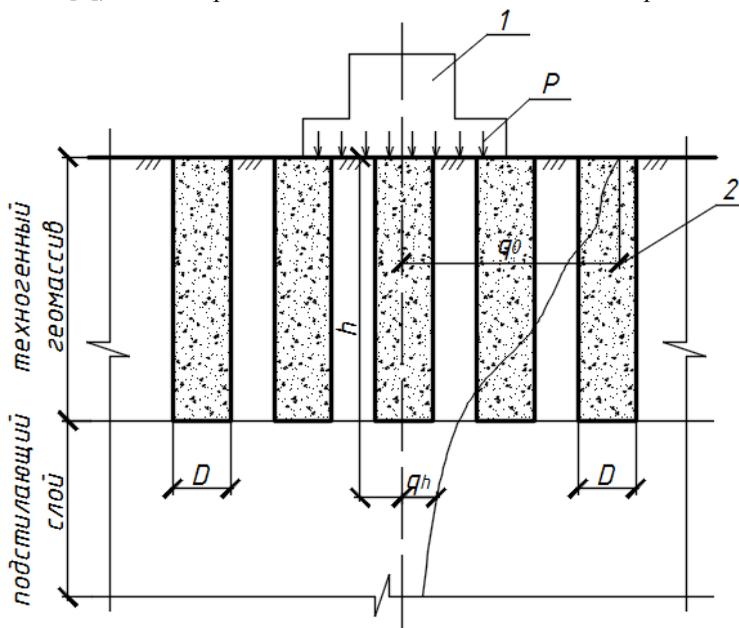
Схема к расчету осадок фундаментов на техногенных геомассивах из щебеночных свай:
